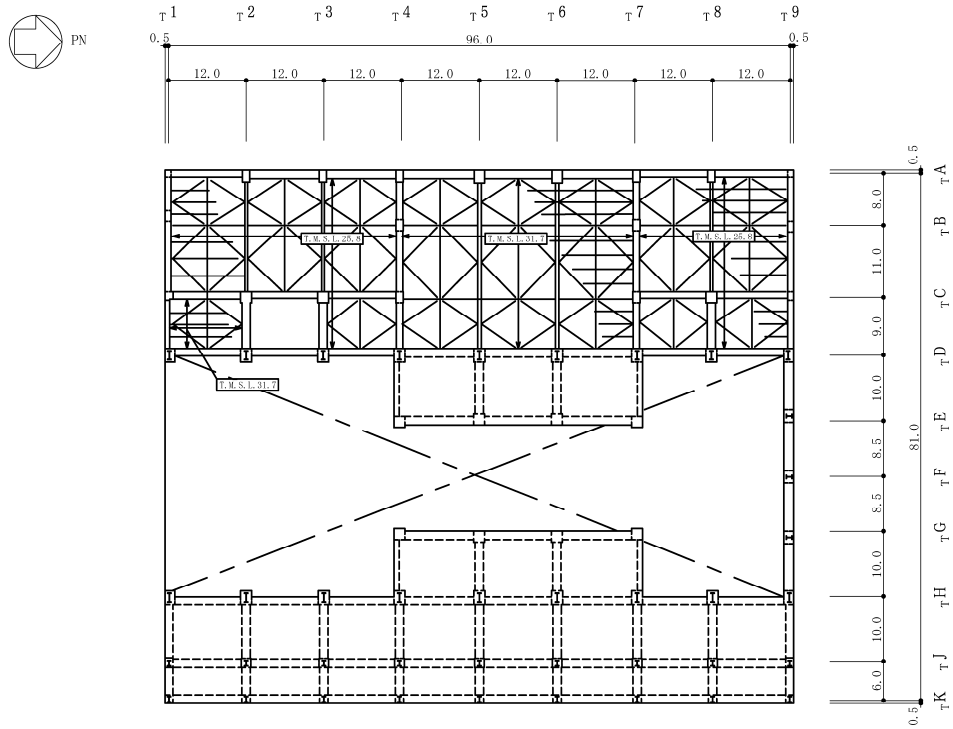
タービン建屋の概略平面図 (3F, T.M.S.L. 30.9m) (5/6) (単位 : m)
